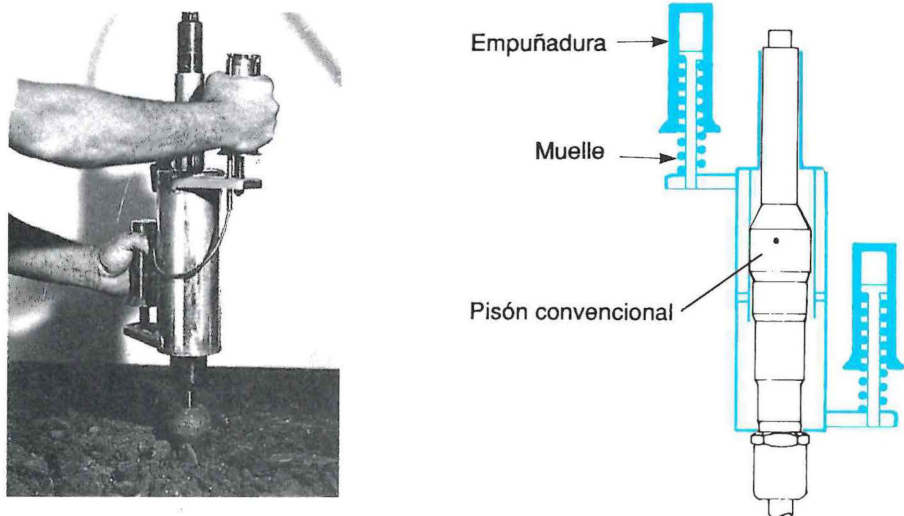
Pisón neumático equipado con empuñaduras suspendidas.
